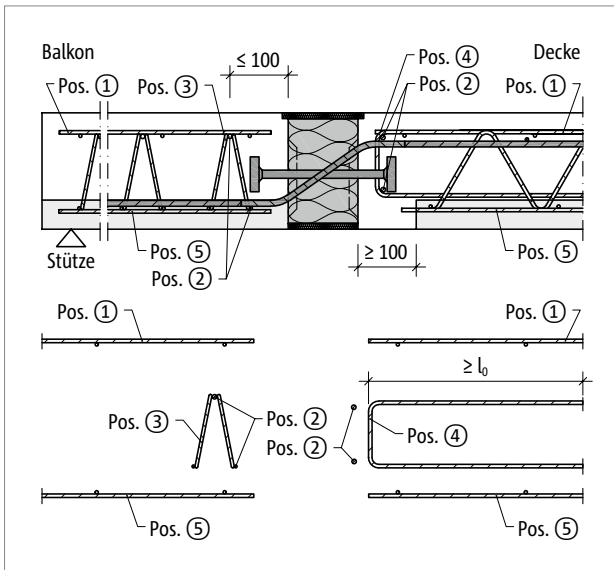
Schöck Isokorb® XT Typ QP: Bauseitige Bewehrung mit Gitterträger
